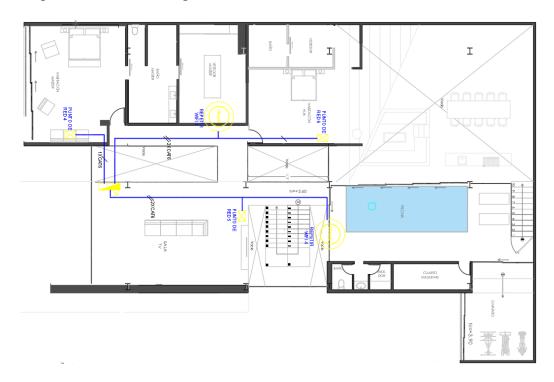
Diseño Plano Red de Datos segunda planta.
